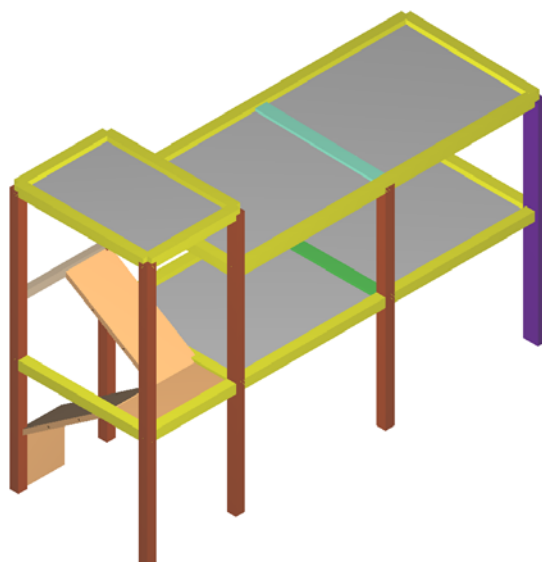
Modello agli elementi finiti – Struttura in elevazione – Vista 2
